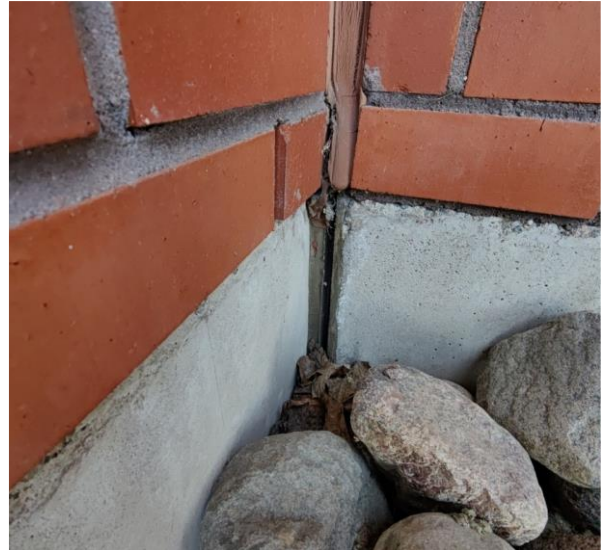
Pohjoissivustan opettajanhuoneen kohdalla sijaitsevan erkkerin kohdalla sokkelien betonirakenteet ovat erittäin huonokuntoisia. Pintateräksiä on näkyvissä ja ruosteessa.
